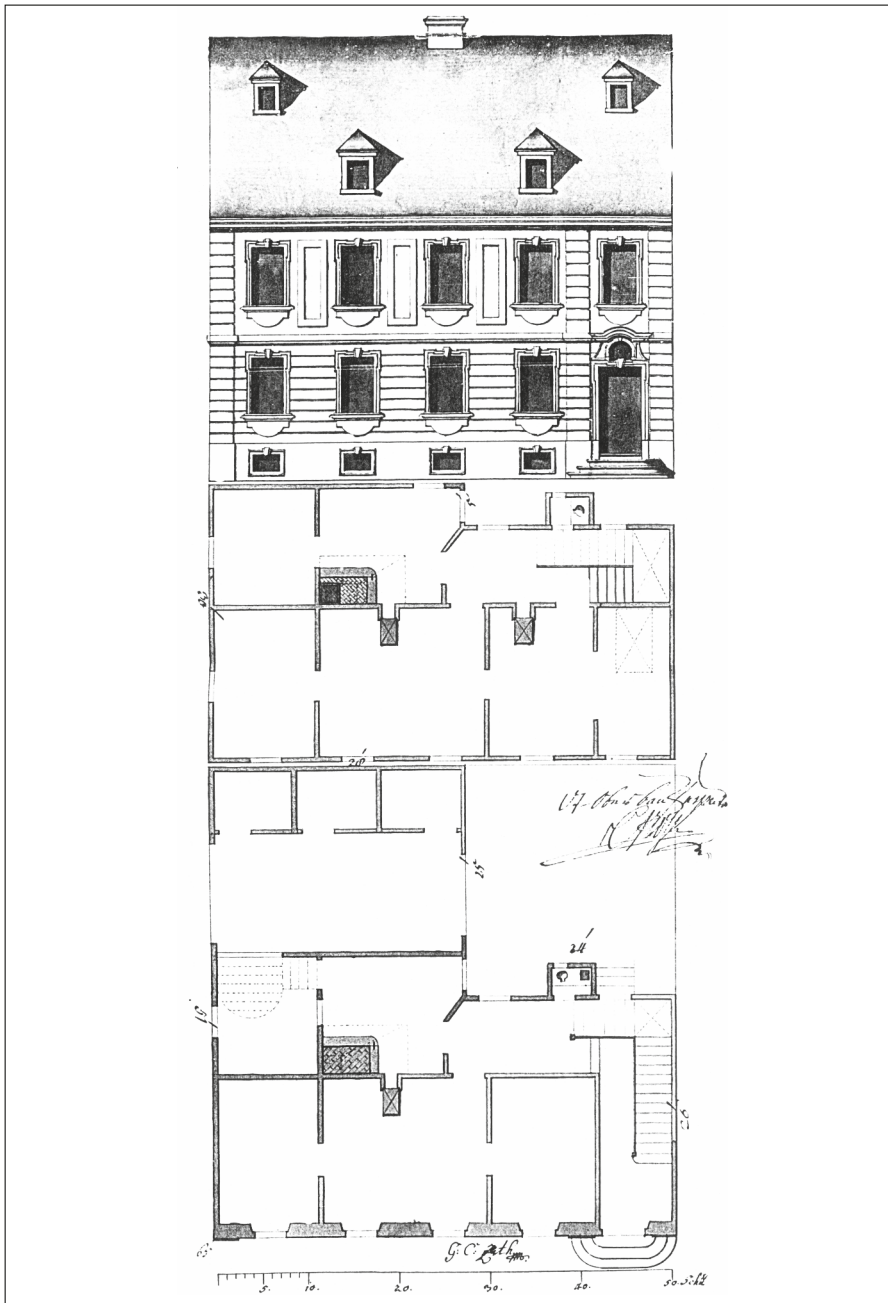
Plan Nr. 24 (Stadtkirchenplatz 5), typisch für Zeichner »A«, individueller Grundriss, aufwändiges Oberlichtportal, signiert G. C. Zith, geplant 1772.
